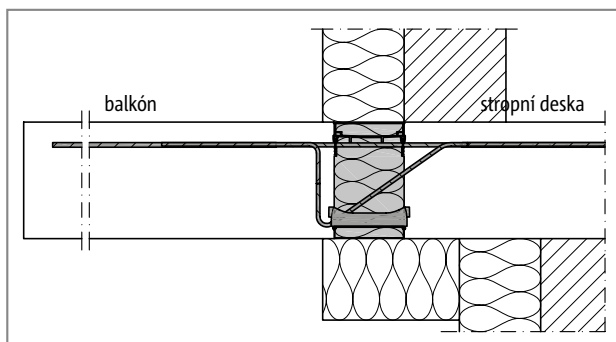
Schöck Isokorb® typ KXT, QXT+QXT: Balkón ve vnitřním rohu, podepřený ze dvou stran
